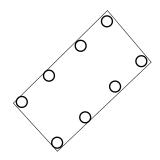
Área de comedor soportado por 8 pilares de madera.
